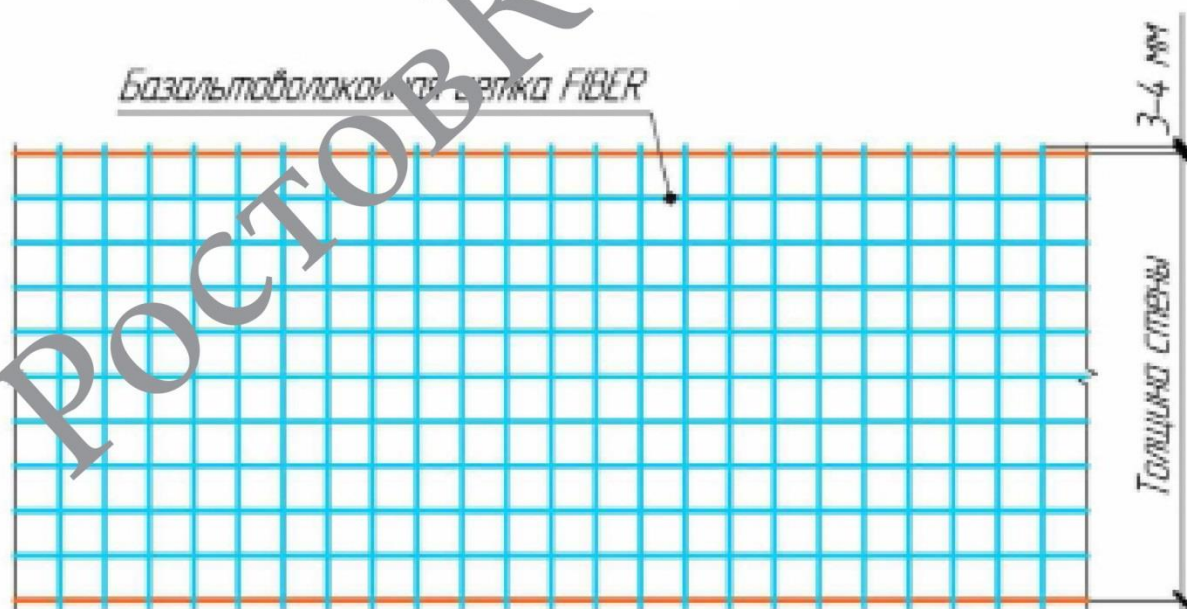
Общий вид армирования каменной кладки сеткой FIBER. План
